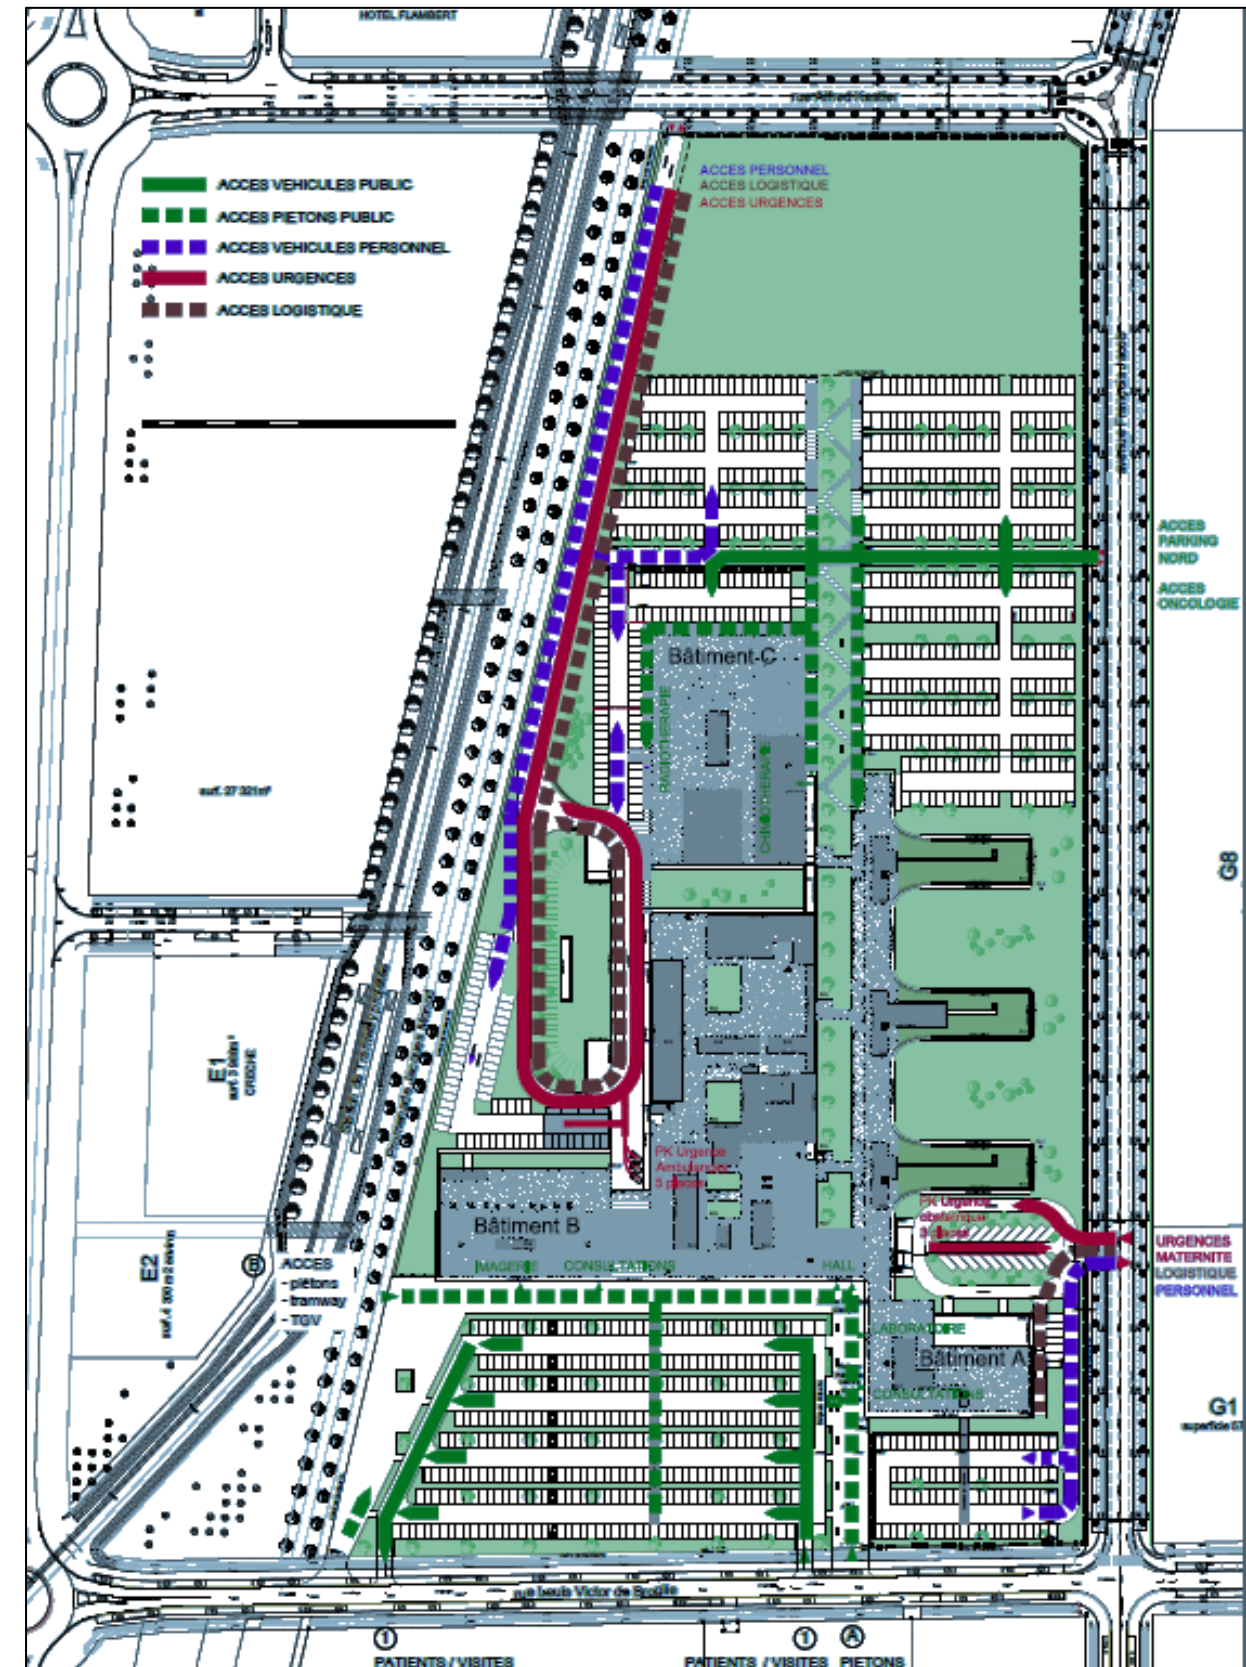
Plan des accès (Notice architecturale annexée au permis de construire)
